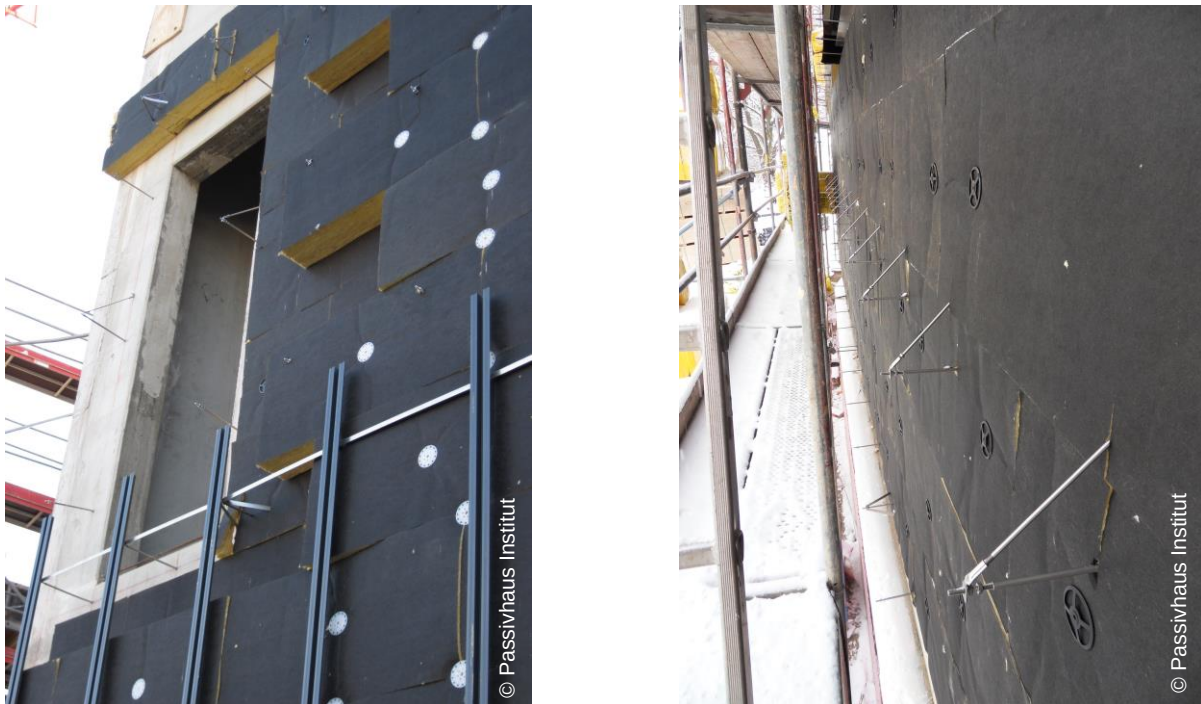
Vorgehängte hinterlüftete Fassade mit Mineralwollgedämmung. Besonderes Augenmerk wurde hier auf die wärmebrückenarme Unterkonstruktion mit Gelenkstäben gelegt.]
